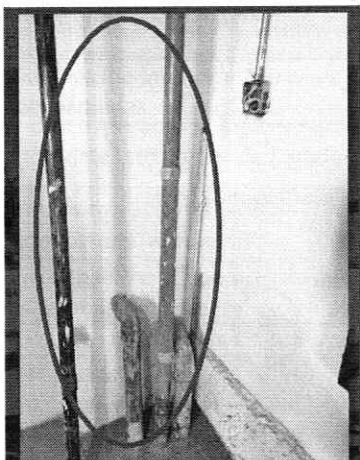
Instalaciones ajenas (tuberías en sala de máquinas).
